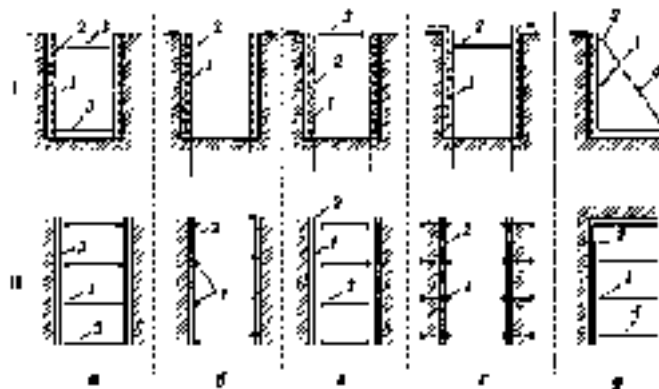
Схемы крепления вертикальных стенок выемок: I — поперечное сечение траншеи; II — план расположения креплений; а — стоечно-распорное крепление; б — консольное крепление; в — консольно-распорное крепление; г — консольно-анкерное крепление; д — подкосное крепление; 1 — стойка; 8 — щиты (доски); 3 — распорка; 4 — подкосы
